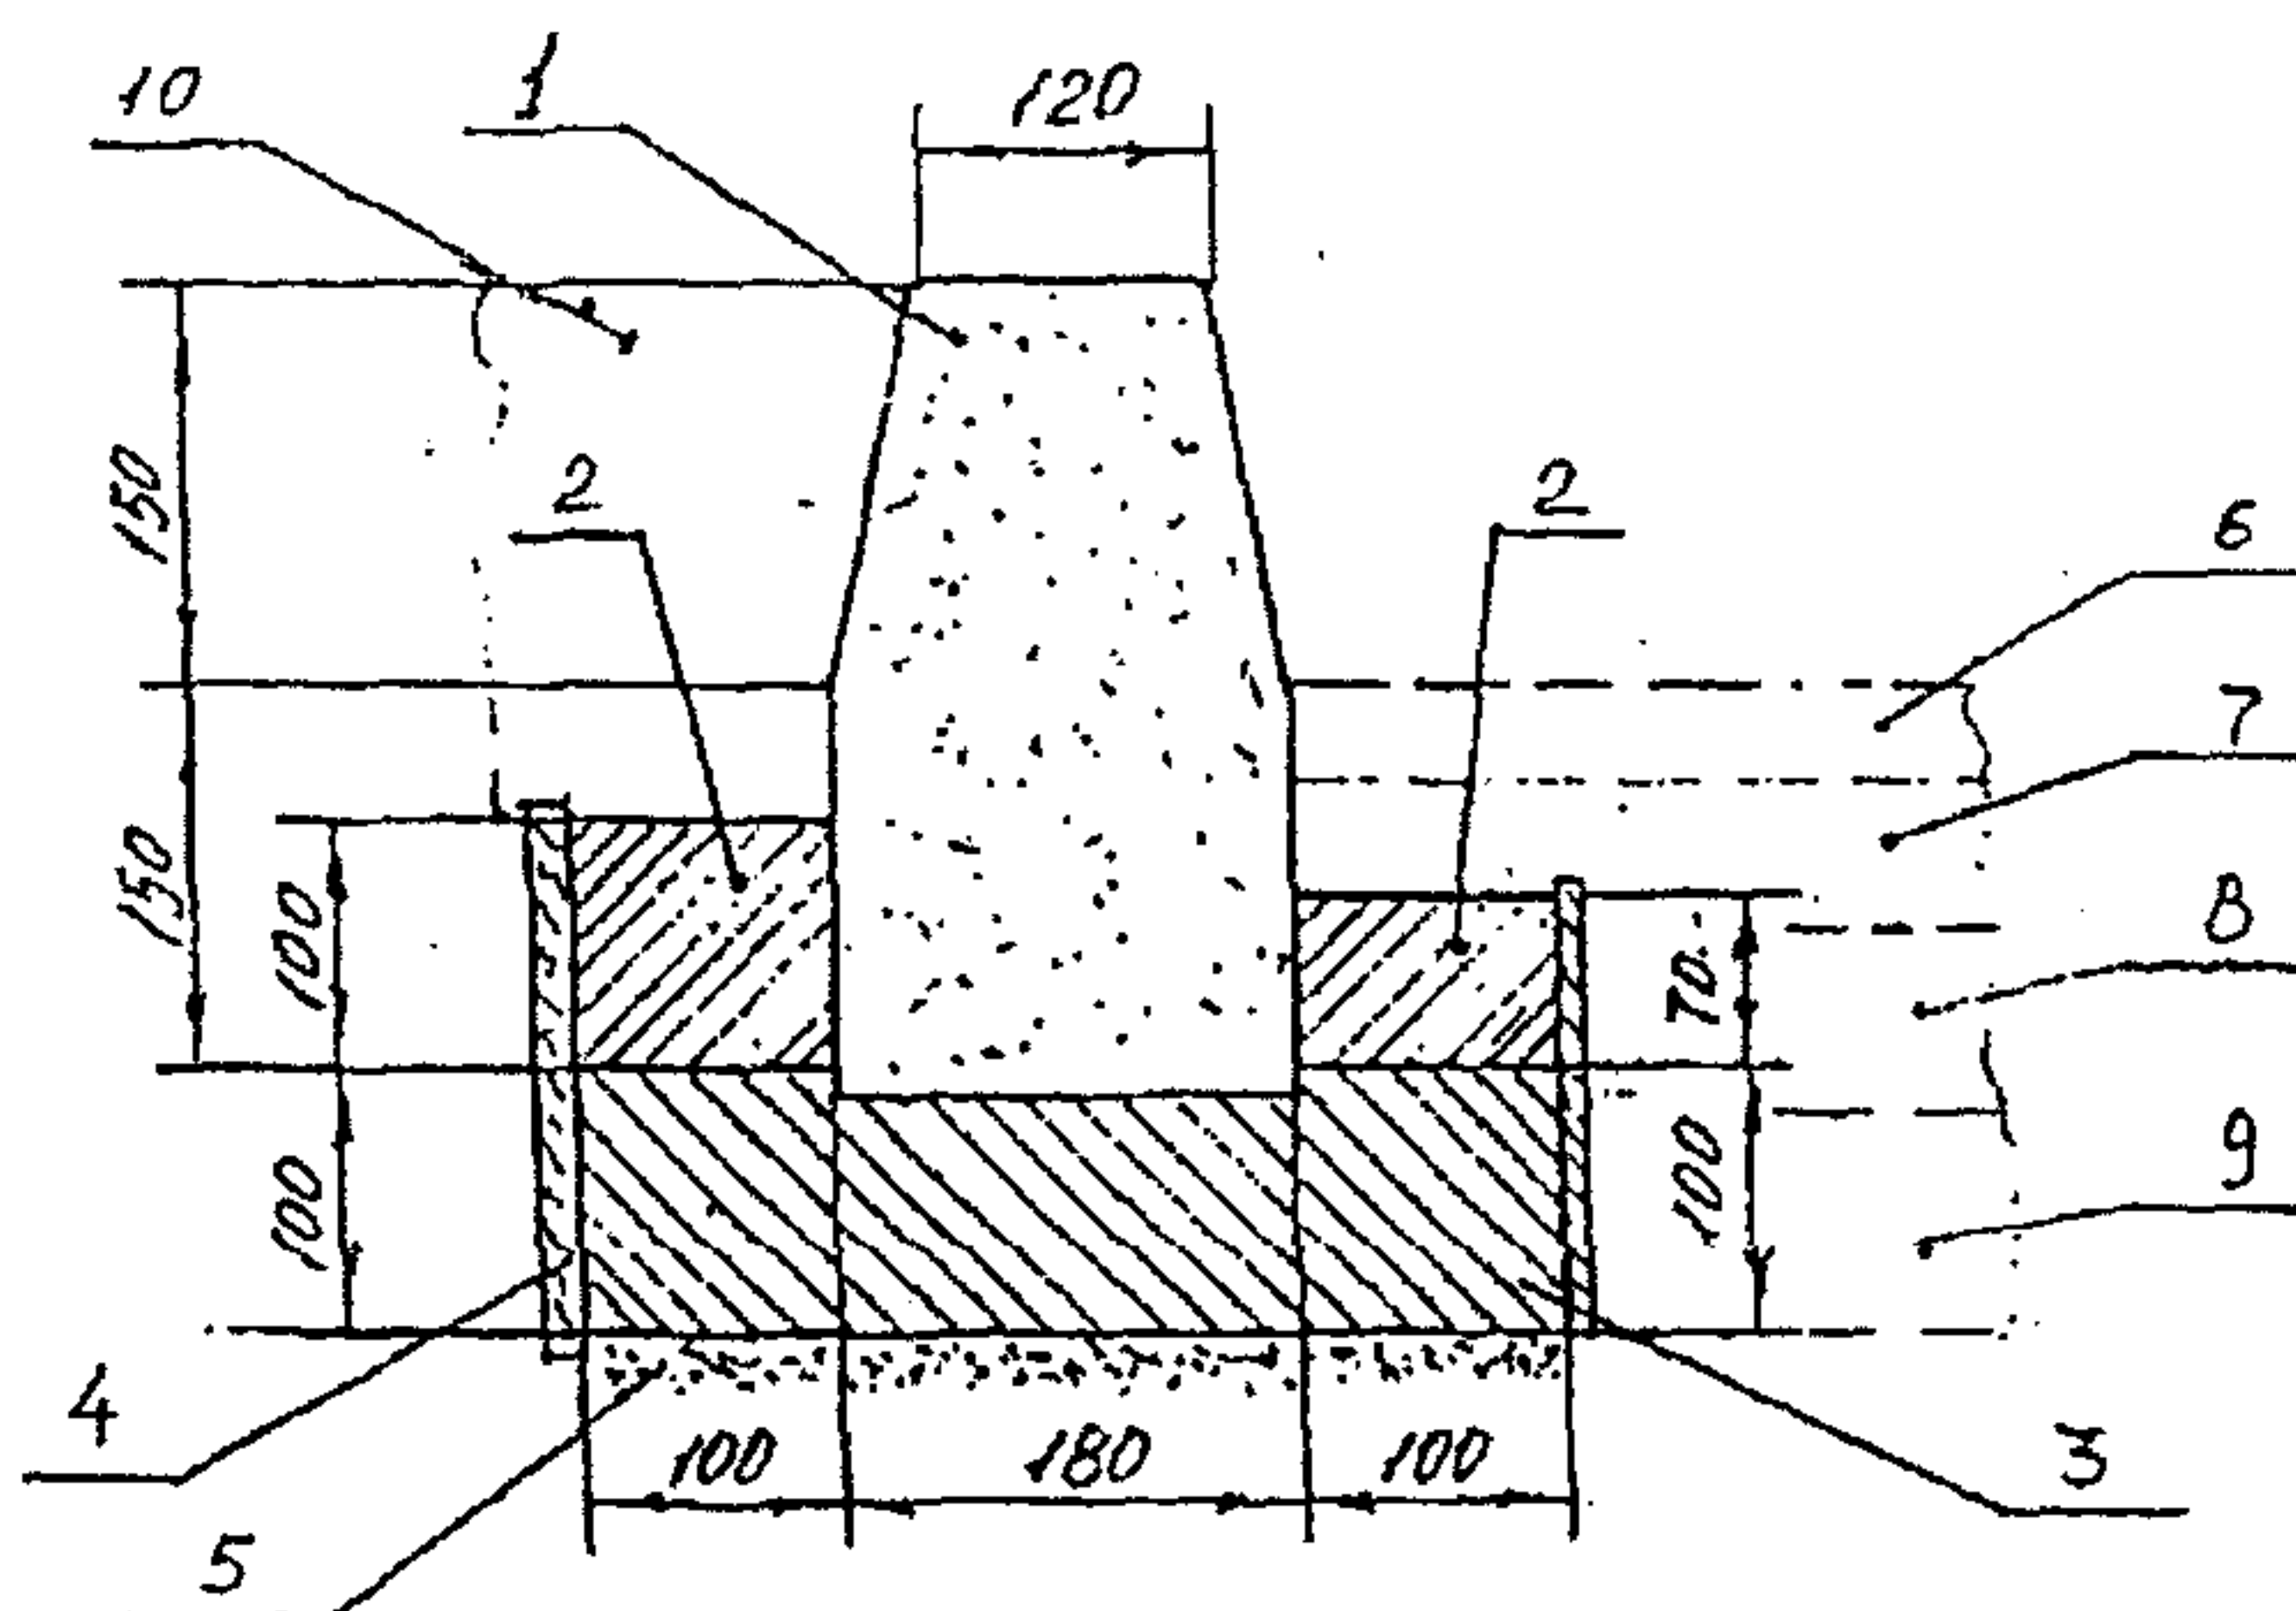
1 - бортовой камень; 2 - бетонная обойма; 3 - бетонное основание под бортовой камень; 4 - опалубка; 5 - песчаный подстилающий слой; 6 - верхний слой асфальтобетона; 7- нижний слой асфальтобетона; 8 - бетонное основание дороги; 9 - технологический слой дороги; 10 – тротуар
